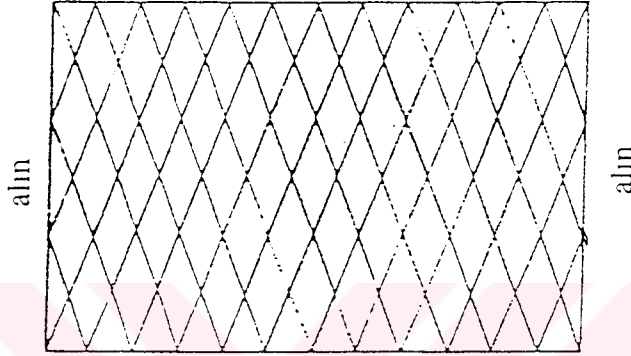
Üç Doğrultulu ağ kabuk planı
